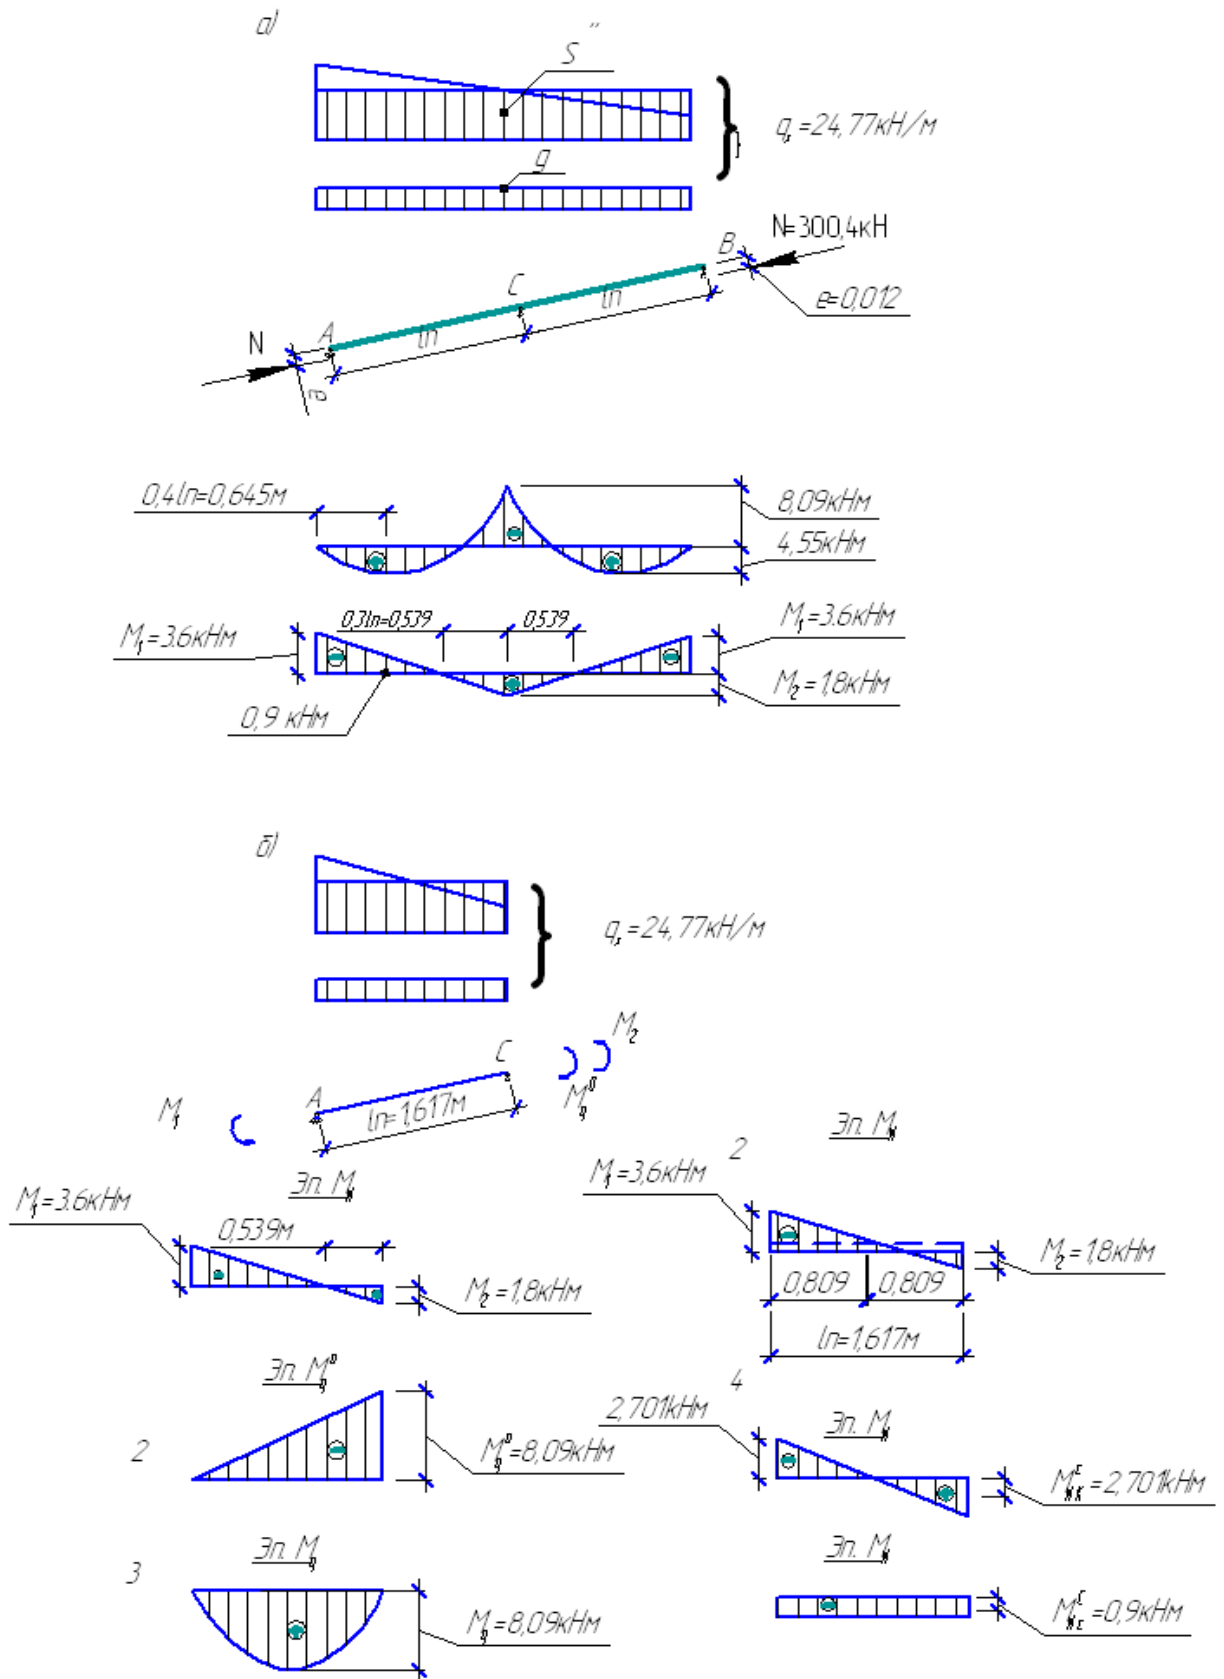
К расчету верхнего пояса многоугольной фермы
